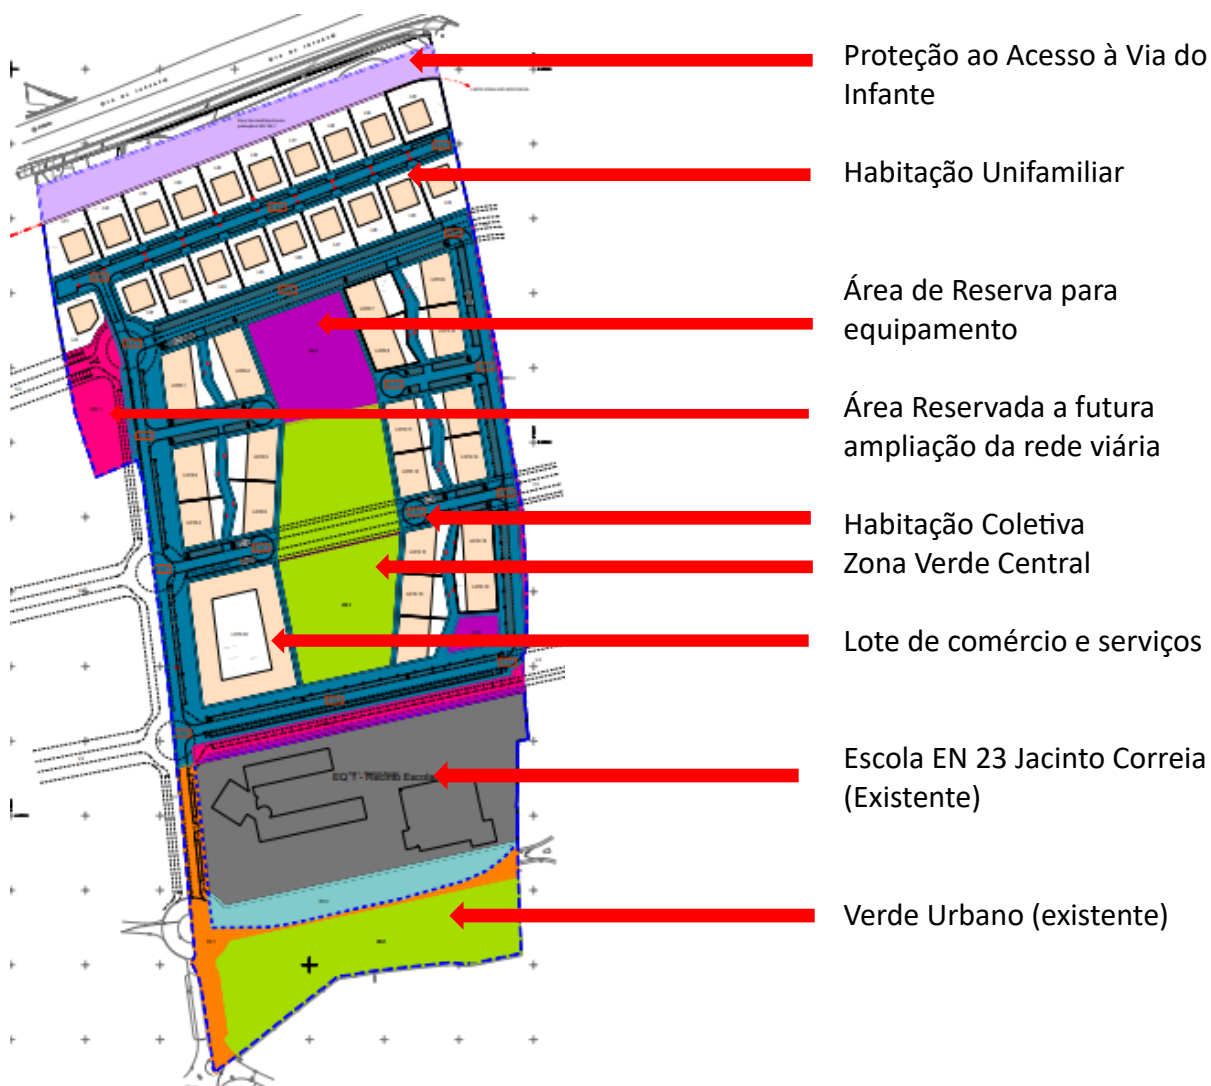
Planta Síntese do Projeto de execução do Loteamento de Lagoa Norte (Julho 2023)
